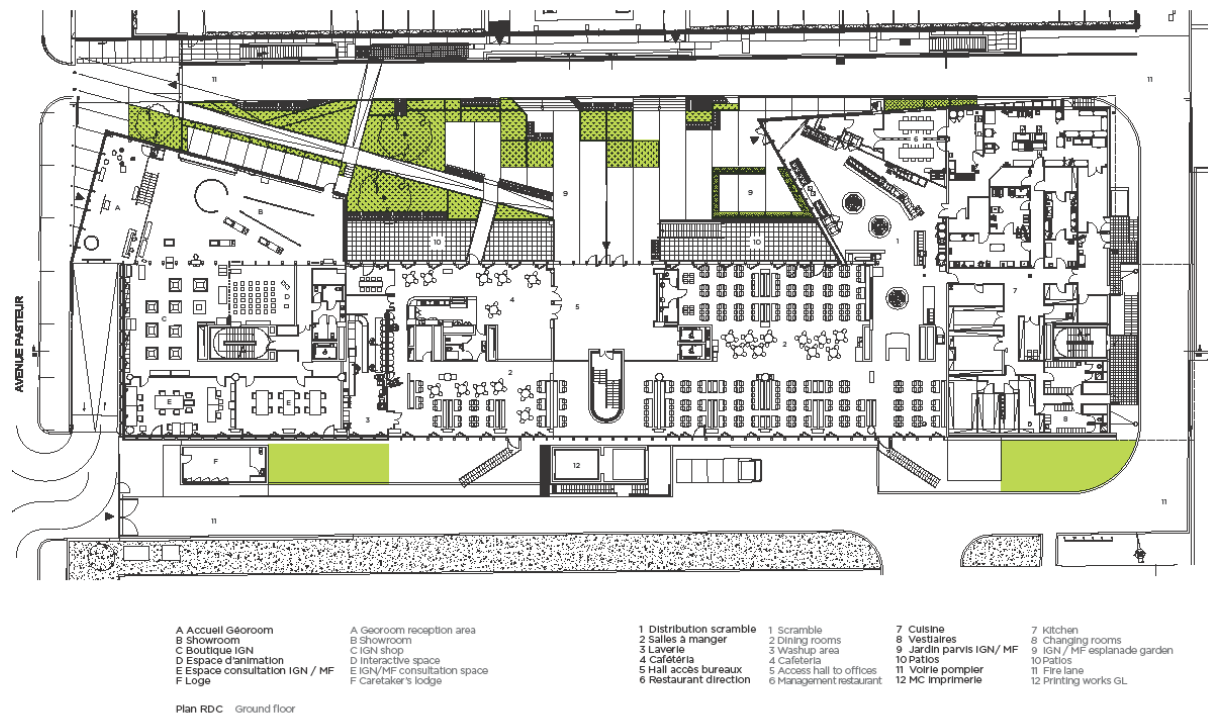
plan niveau rez de chaussée nord ©Architecture Patrick Mauger
